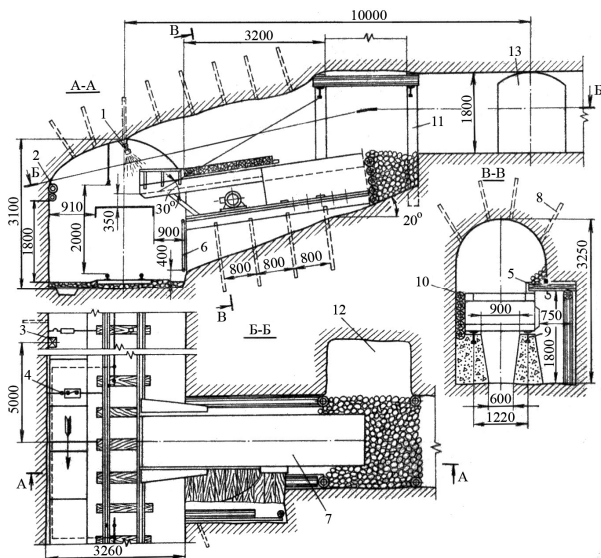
Схематический вид питателя вибрационного унифицированного ПВУ: 1 – ороситель; 2 – трубопроводы; 3 – пульт управления; 4 – секционный разъединитель; 5 – полок; 6 – ограждение; 7 – питатель ПВУ; 8 – анкерное крепление выработки; 9 – фундамент; 10 – закладочные бревна; 11 – крепь устья дучки; 12 – выпускная дучка; 13 – вентиляционная выработка
